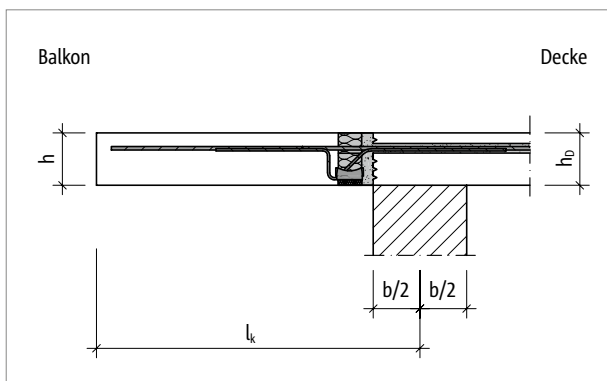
Schöck Isokorb® RT Typ K: Statisches System; direkte Lagerung
